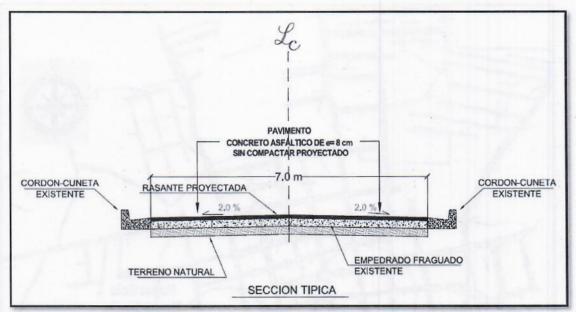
Detalle de la sección típica de la 4ª Calle Oriente y de la 6ª Avenida Sur.
